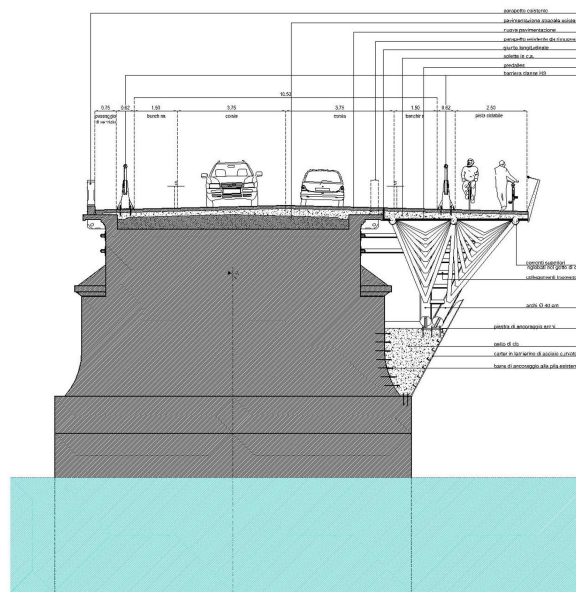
Sezione trasversale e accostamento ponte storico con il nuovo intervento
